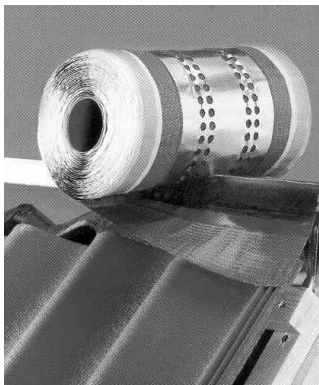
Centrer sous-faîtière sur la latte de faîtière
